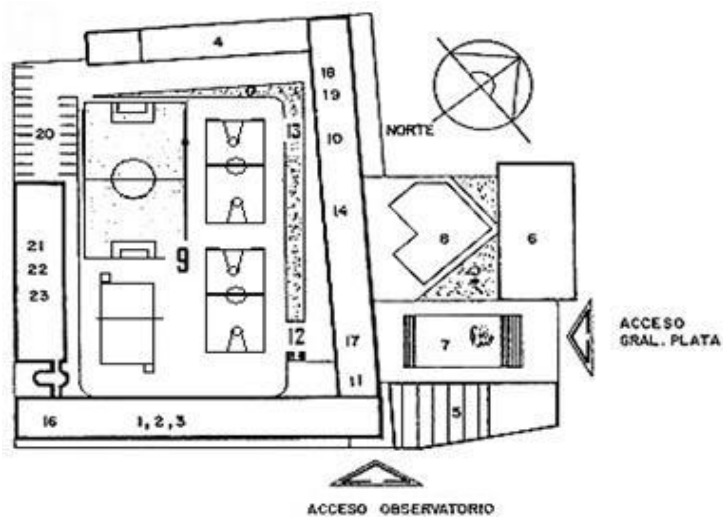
Planta arquitectónica. Esquema tipo cuartel.
